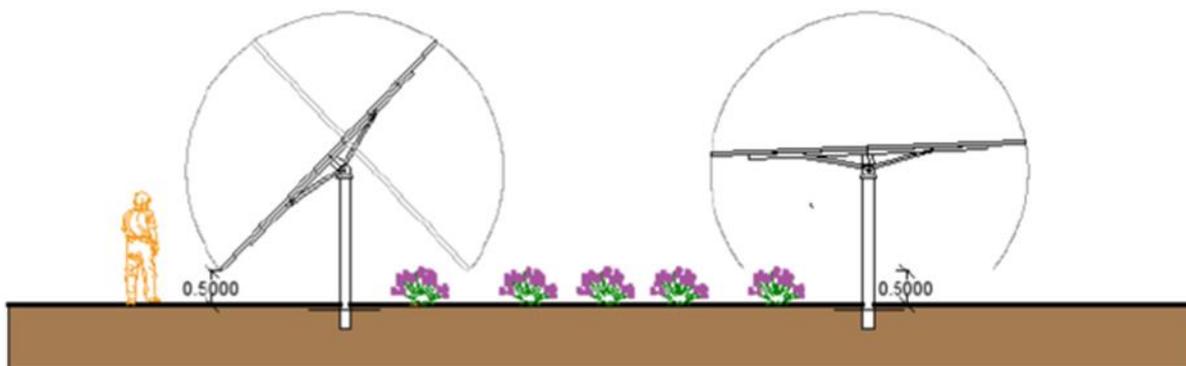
Sesto di impianto per lavandeto meccanizzabile e disposizione lavanda tra interfile e sotto tracker – vista in sezione
